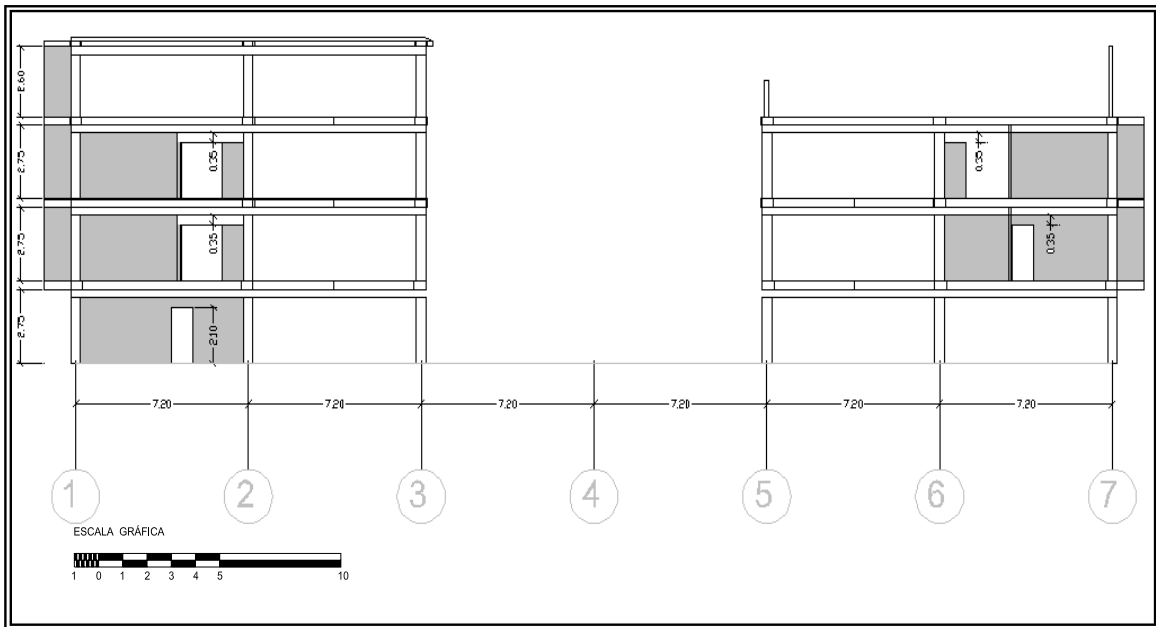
Pórtico B (este-oeste) mostrando las paredes de mampostería y la longitud efectiva de columnas
